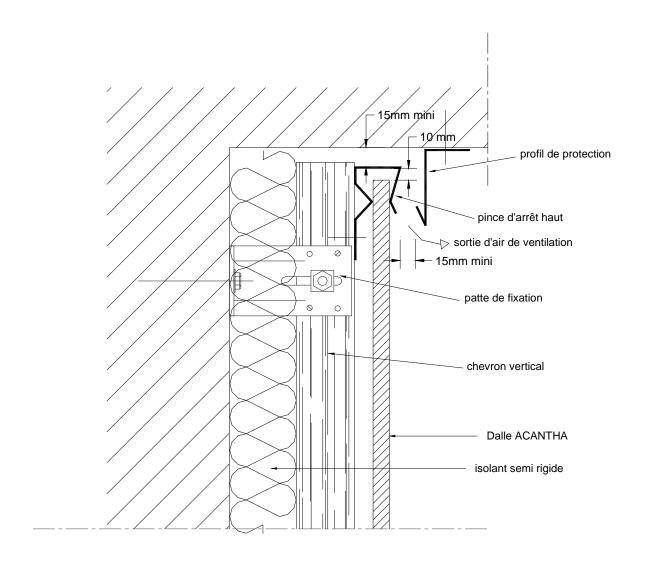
Fixation en rive haute sous corniche – Coupe verticale
